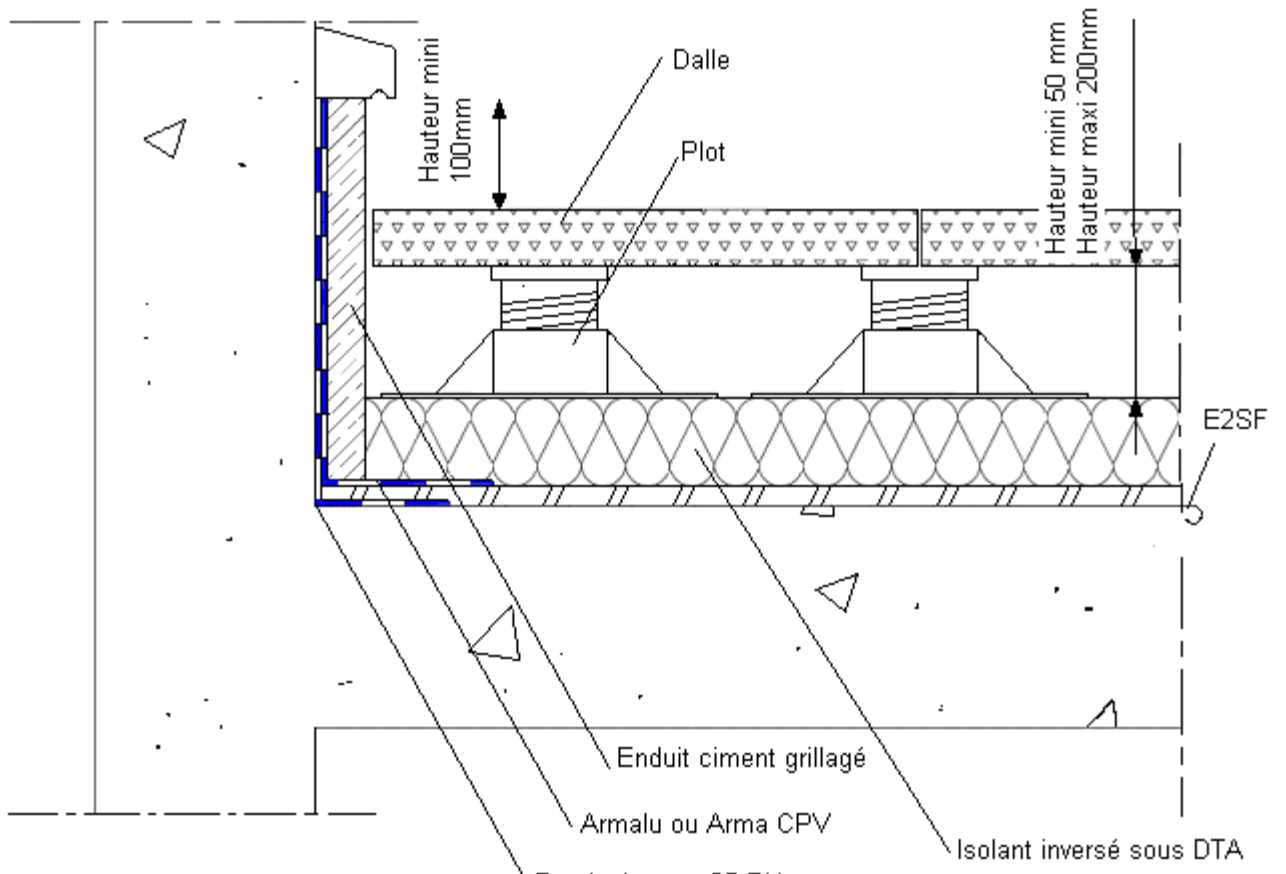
is – Relevé au-dessus du niveau fini des dalles - Terrasse accessible, protection par dalle sur plots
